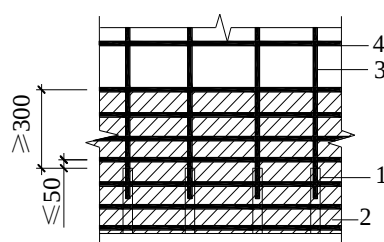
钢筋套筒灌浆连接部位水平分布钢筋加密构造示意
